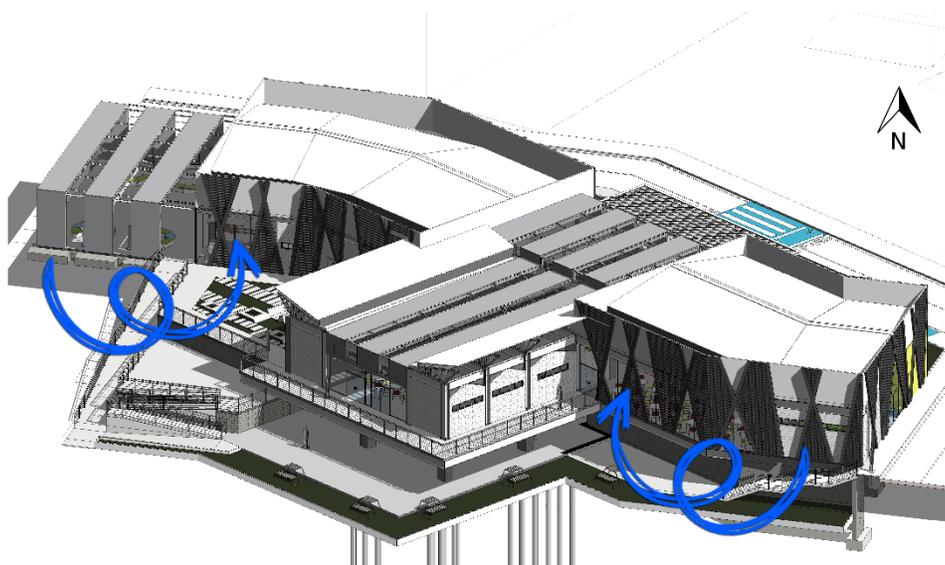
Ventilación del proyecto - Fuente: Elaboración propia
